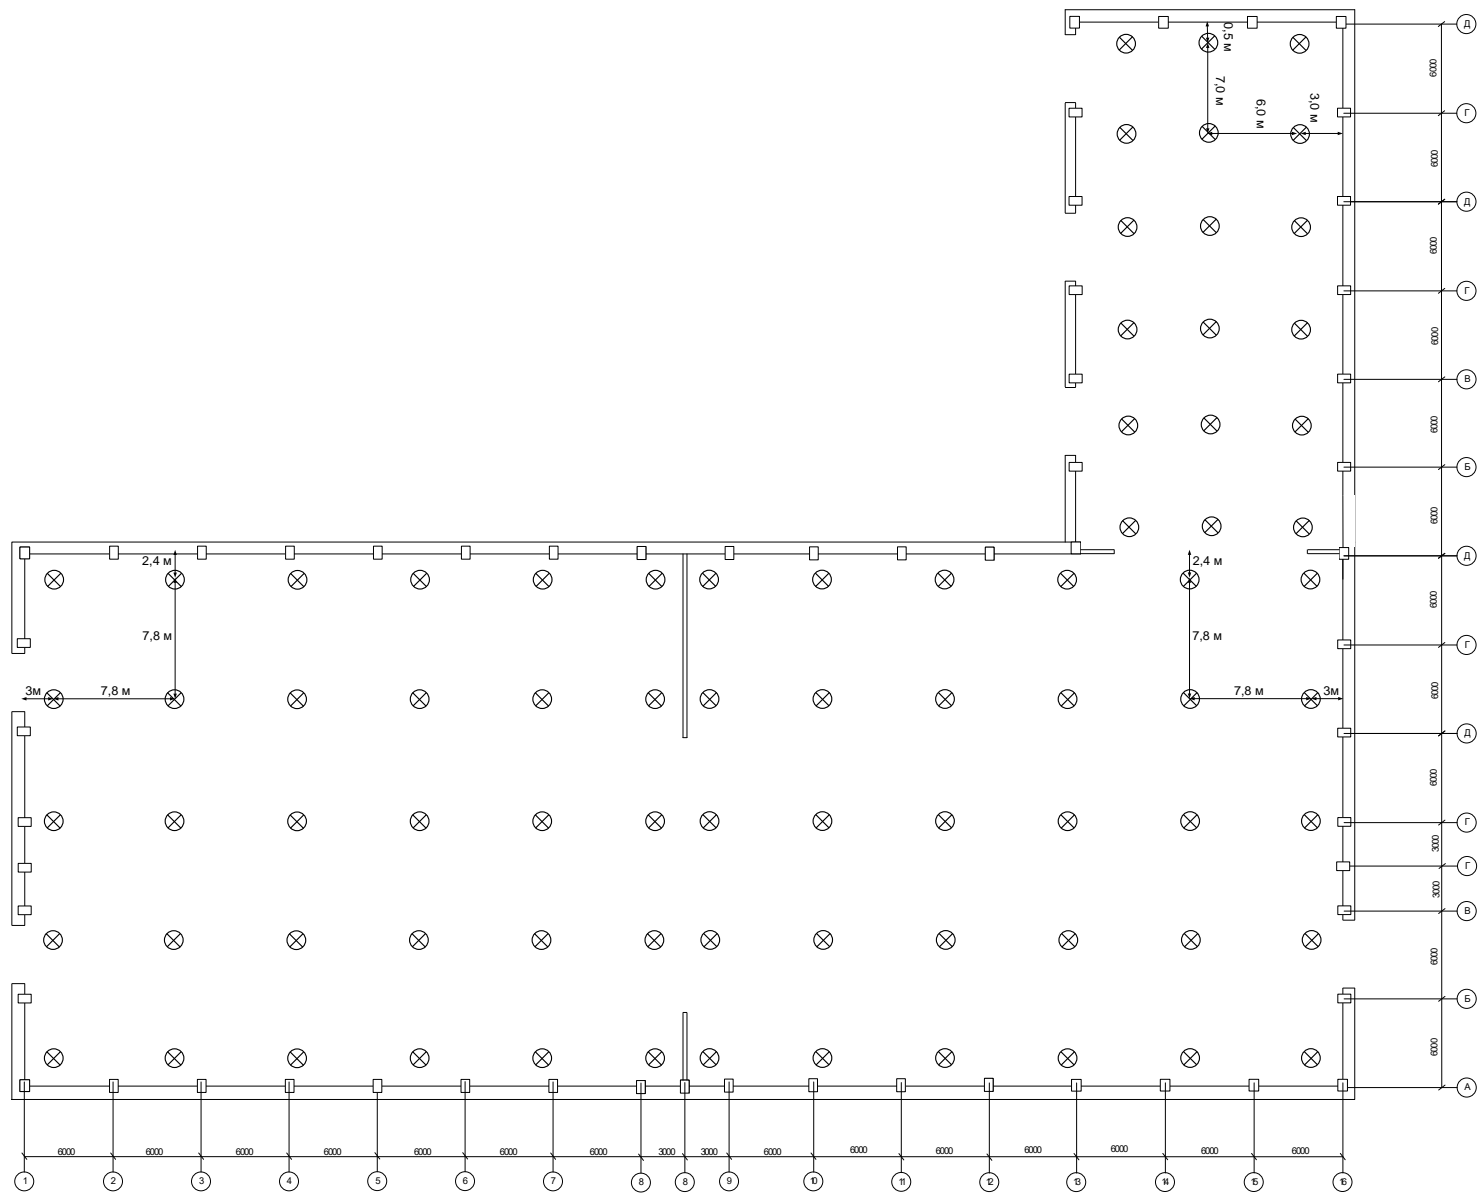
Размещение светильников на плане цеха (аварийное освещение)
